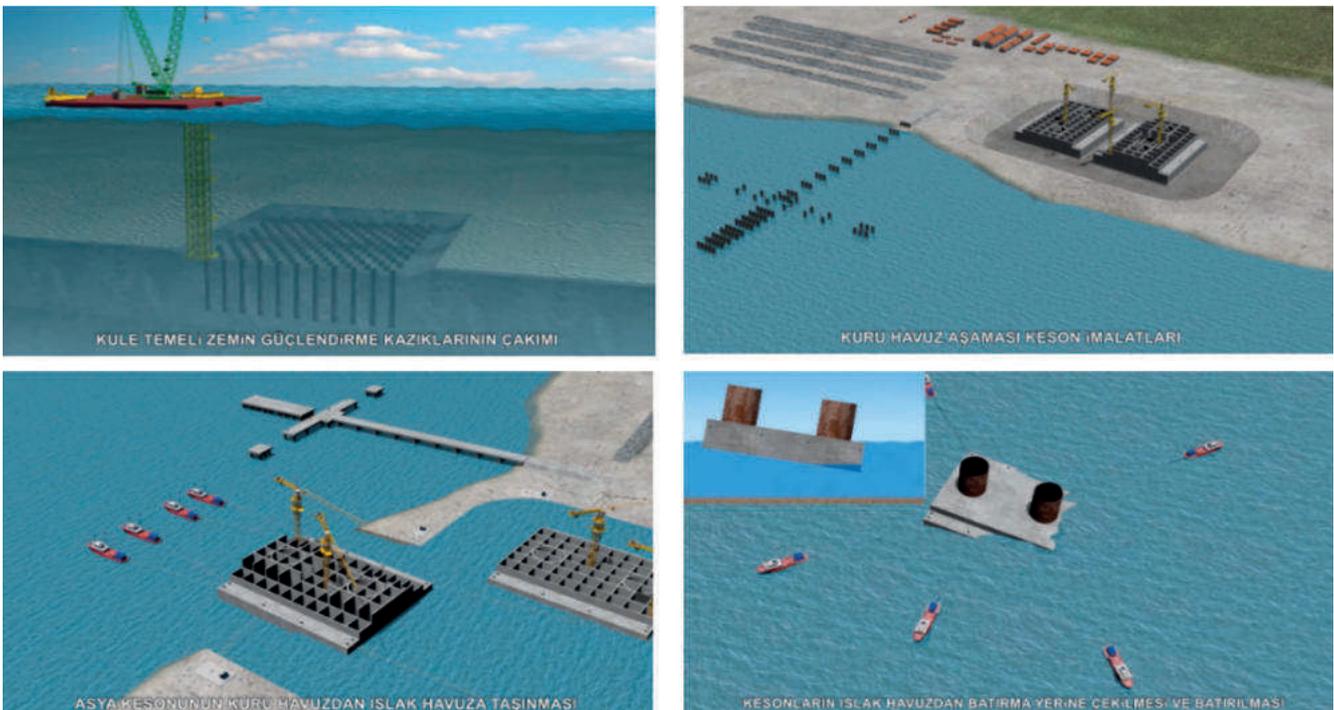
Fasi di realizzazione delle fondazioni del «1915 Çanakkale Bridge» [59].
